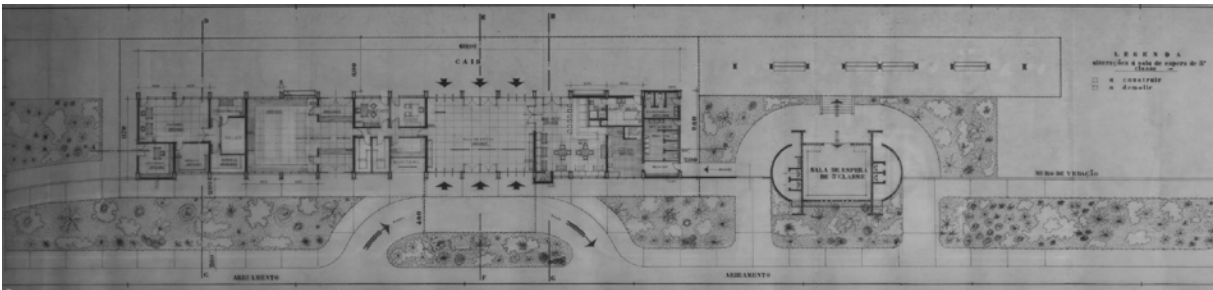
Estação de Vila Pery. Planta do Pavimento, Brigada de Melhoramentos dos C.F.M., 1961.
